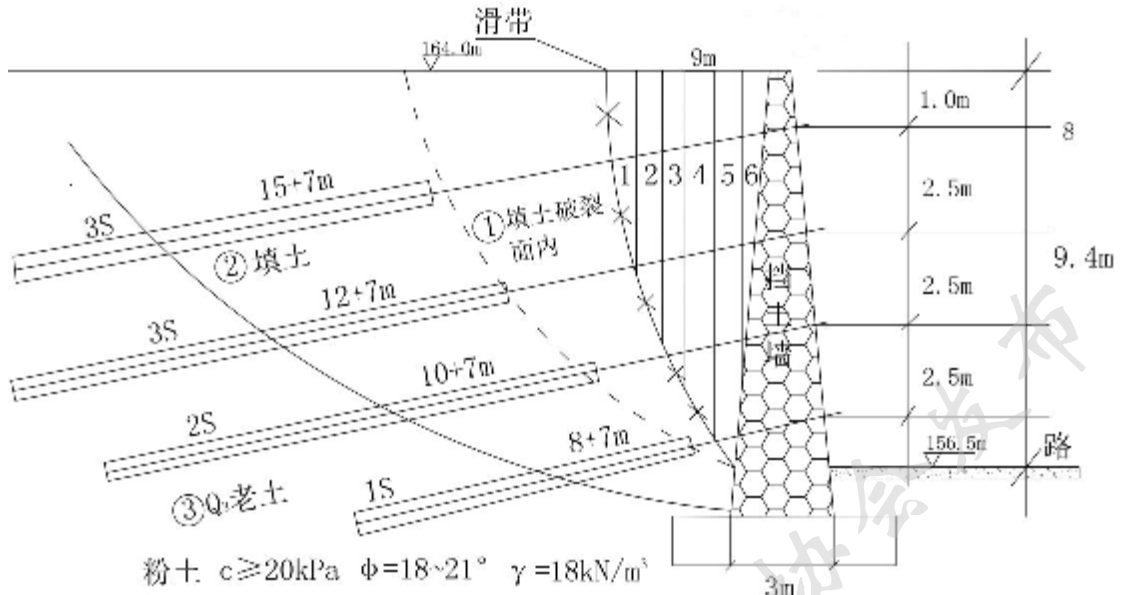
某学校操场填土边坡采用锚索格构梁加固已有挡土墙剖面图
